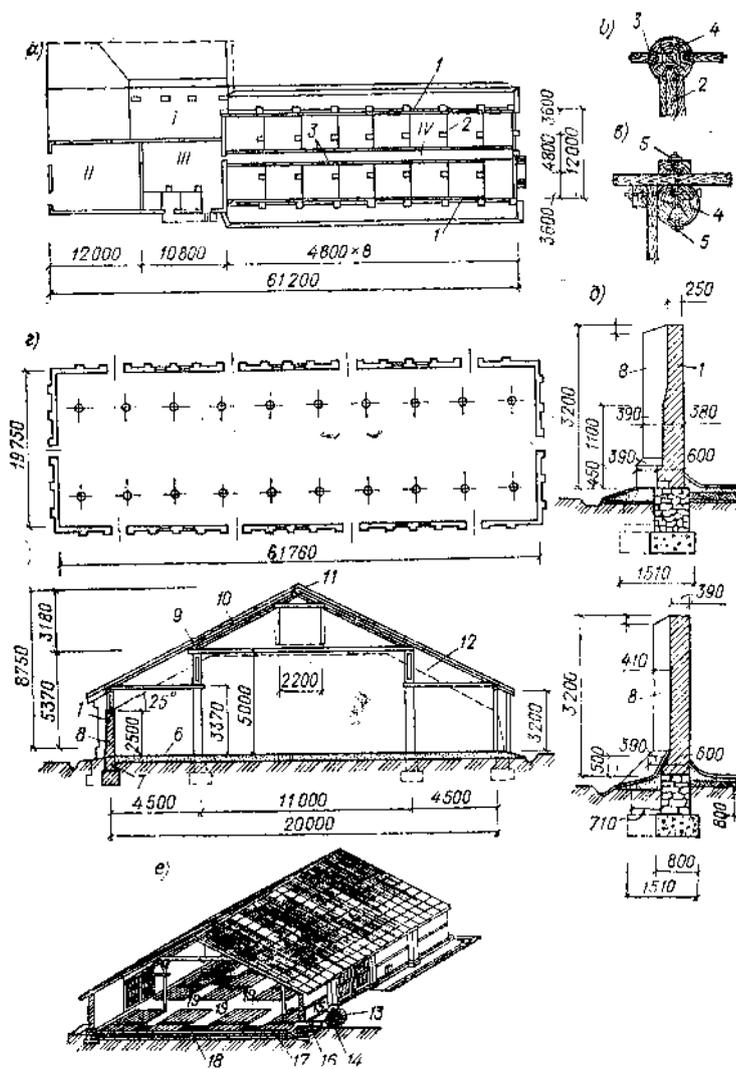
Закромное и напольное зернохранилища из местных материалов
